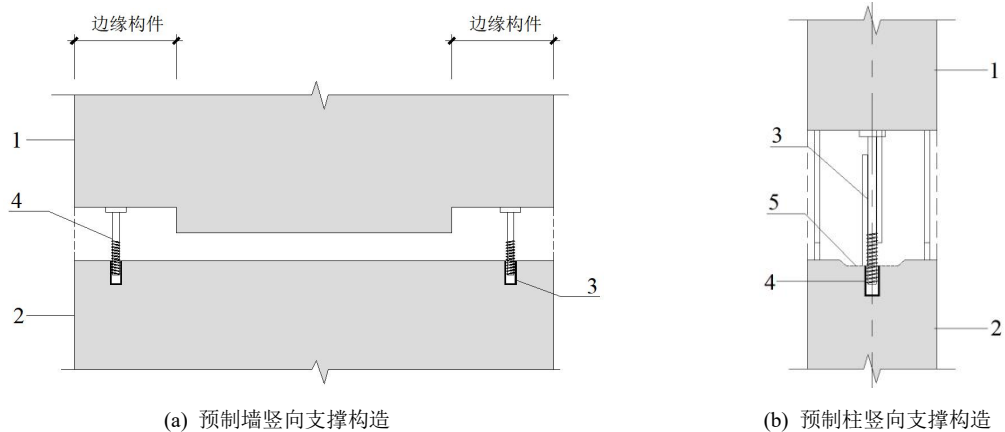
竖向结构构件临时垂直支撑构造示意
